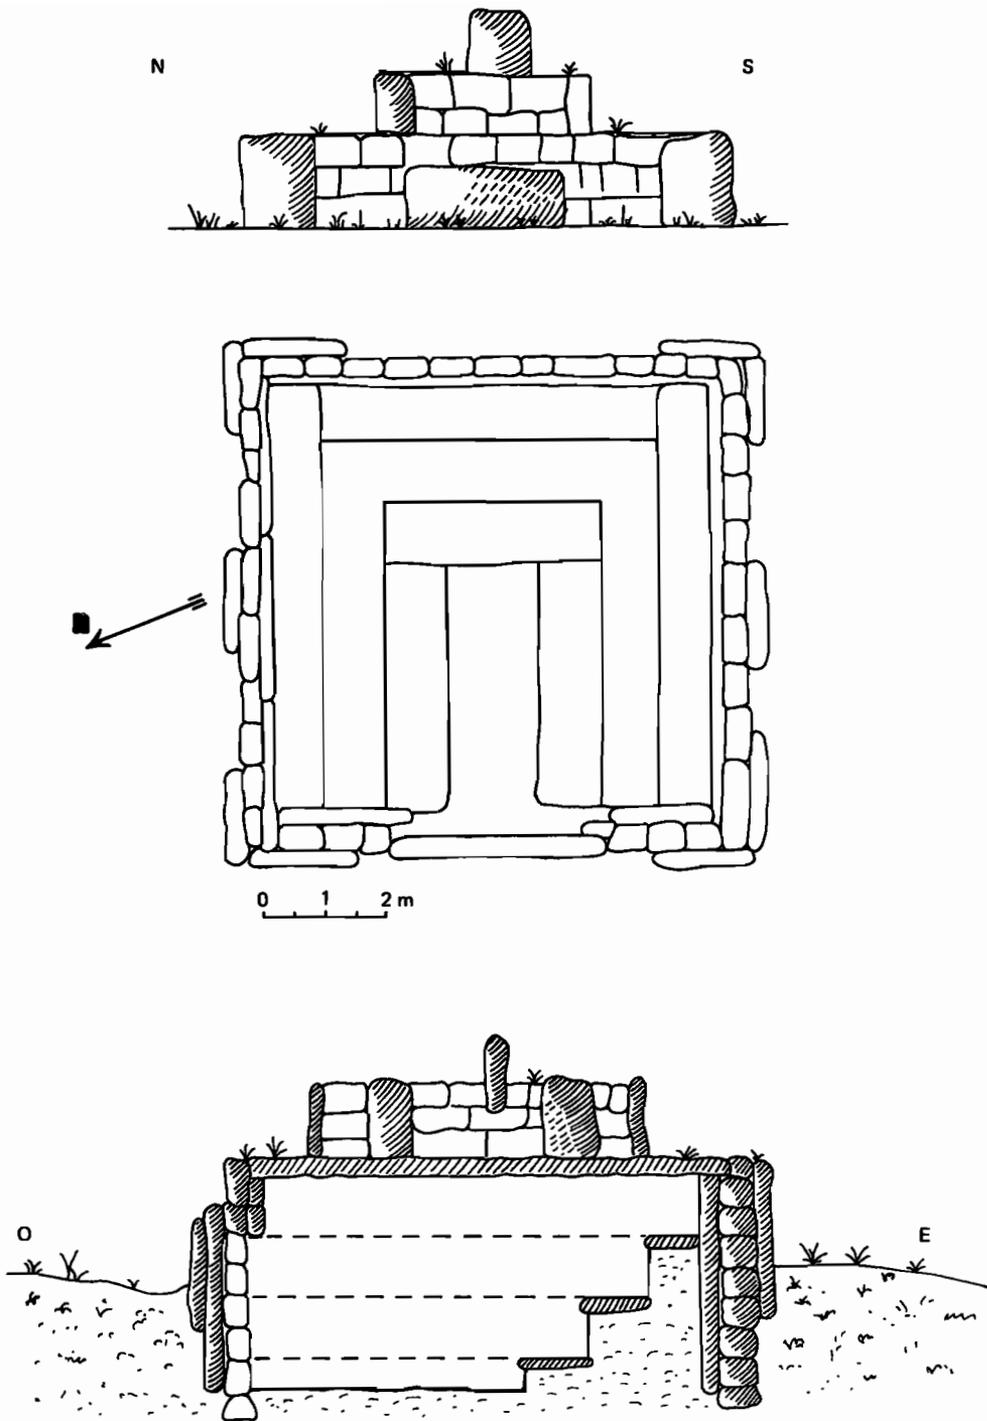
Elévation, plan et coupe d'un tombeau familial mérina.
